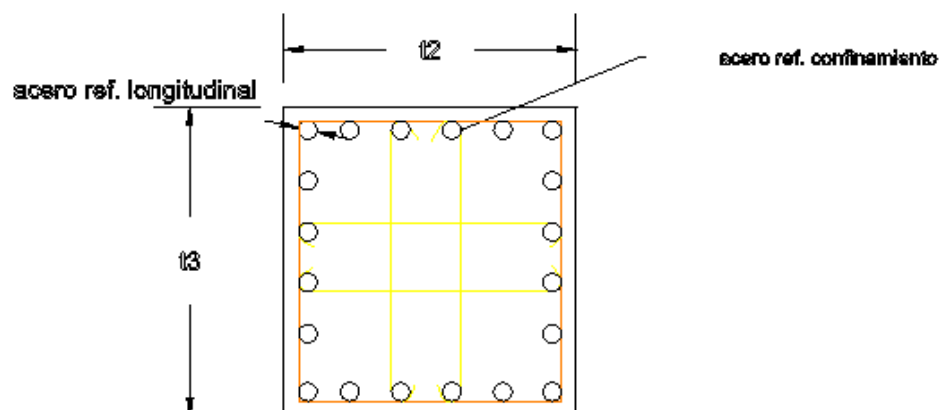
Ilustración de la sección rectangular para el modelamiento de columnas
